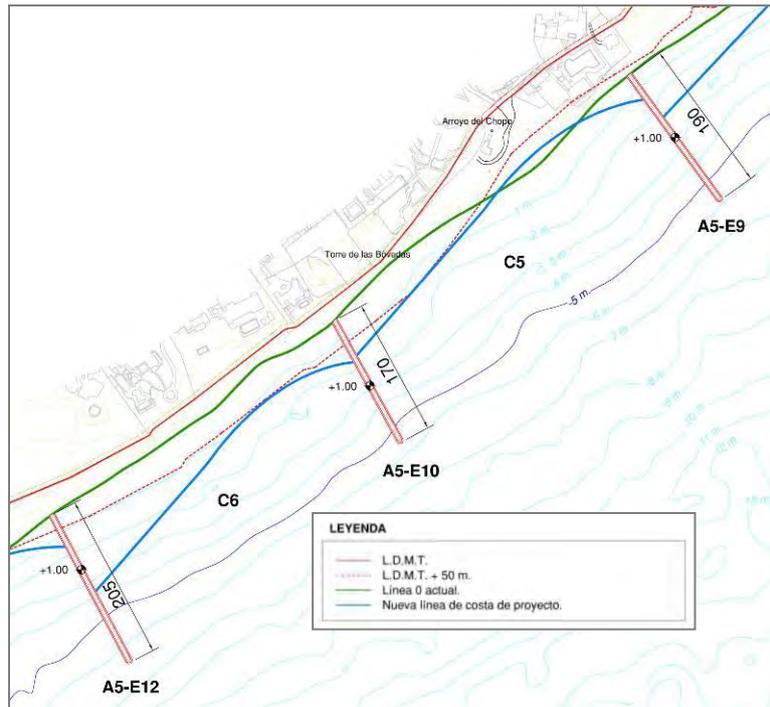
Planta Alternativa 5. Celdas C5-C6.
